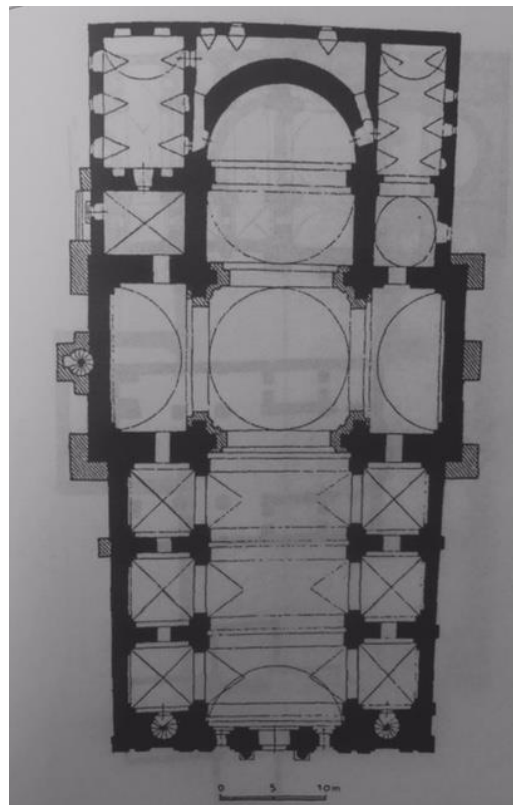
Vergleich des Grundrisses der heutigen SS. Peter und Paul Kirche mit dem Plan Nr. 1056. Die Wände des früheren Entwurfs wurden schwarz markiert.
